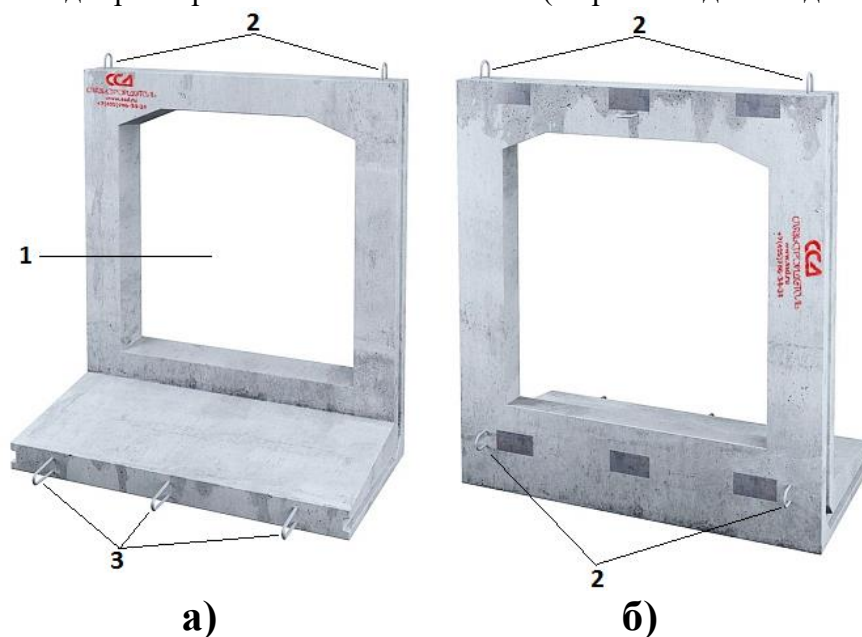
Внешний вид и детали стенового блока «СБ-2»:
